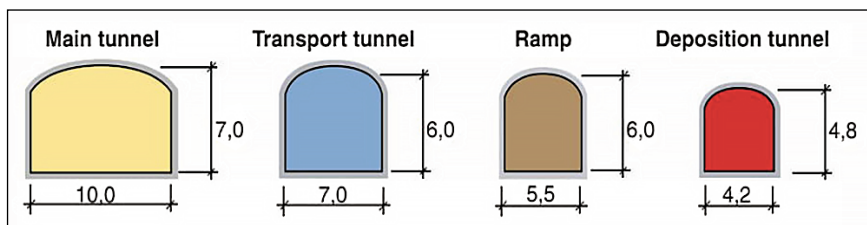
Сечения горных выработок подземного хранилища SFR.
